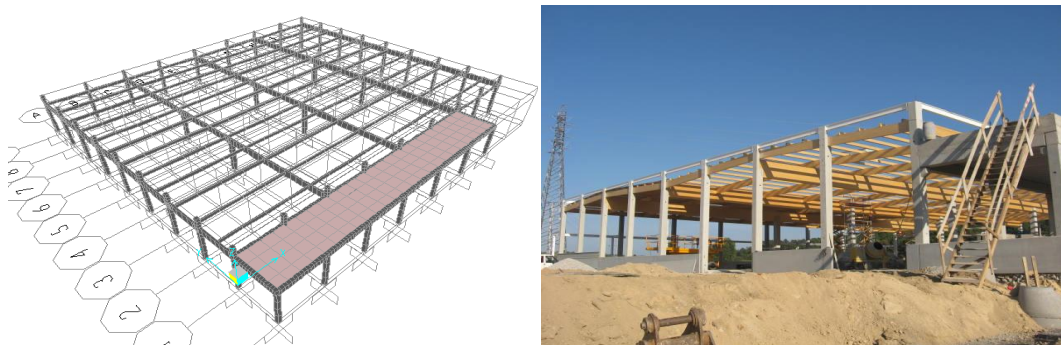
Estrutura do edifício em Projeto e executada em obra
